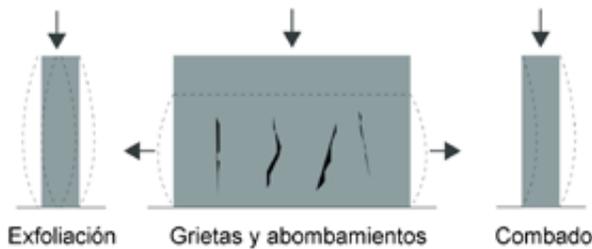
Exfoliación, grietas y abombamientos y combado
